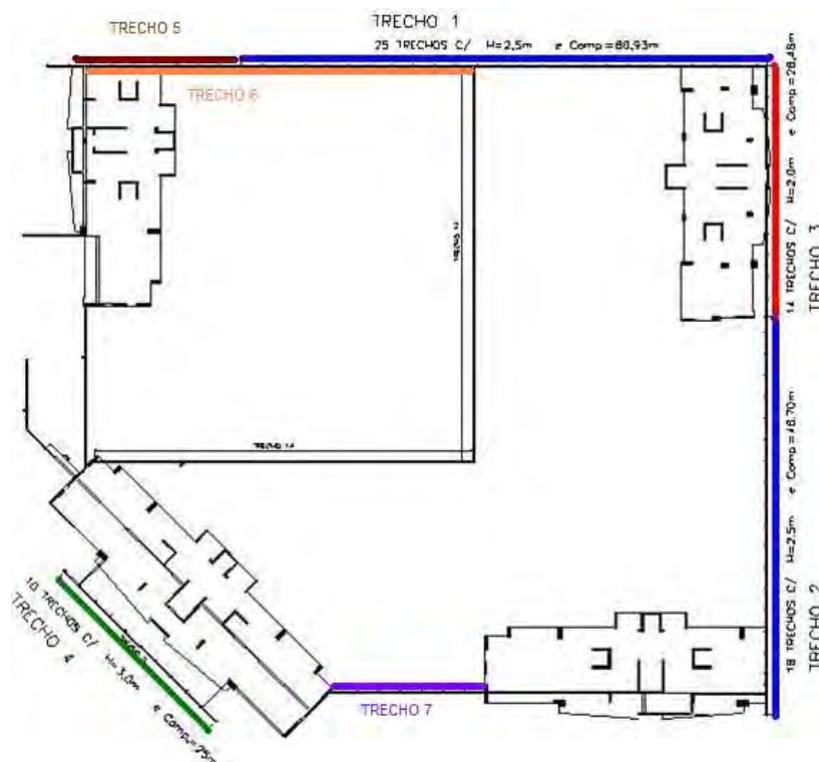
Planta do subsolo onde estão em destaque as cortinas executadas
